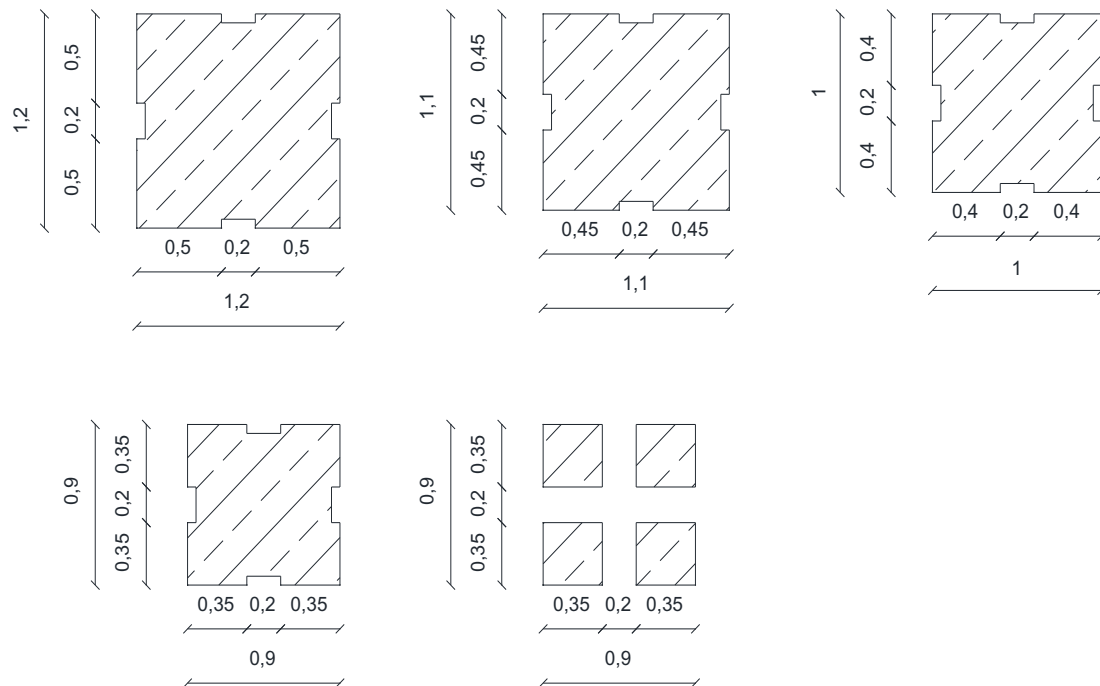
Sezioni trasversali dei pilastri presenti nella struttura.
